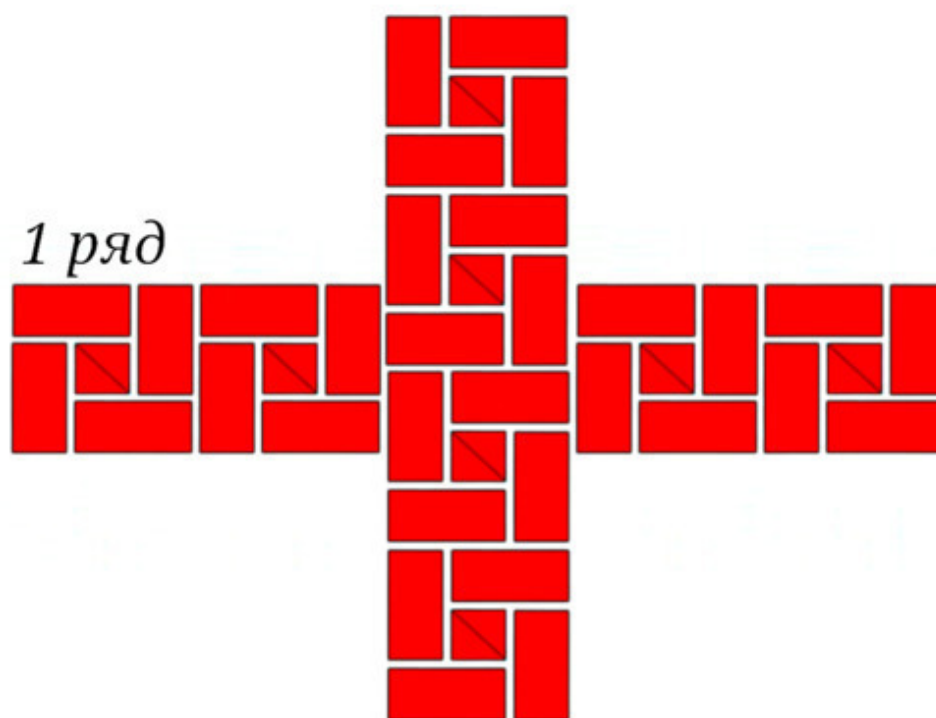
Порядок укладки кирпичей в пересечение стен толщиной в 1,5 и 1,5 кирпича по фламандской системе перевязки кирпичной кладки.
